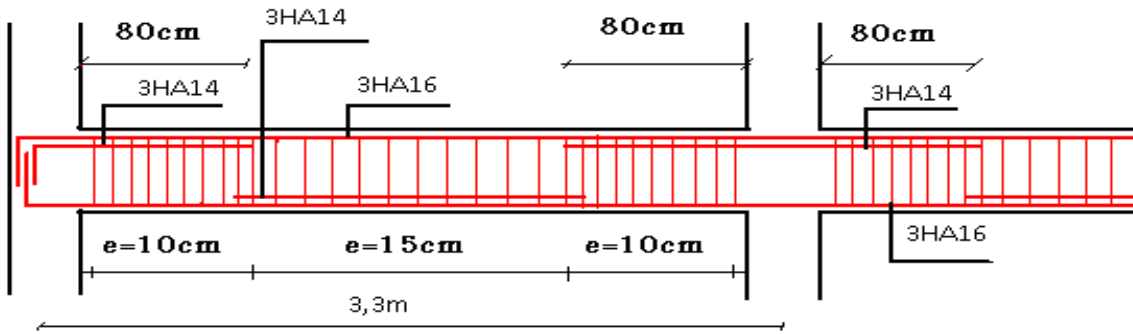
Exemple de dispositions constructives de la poutre principale.
